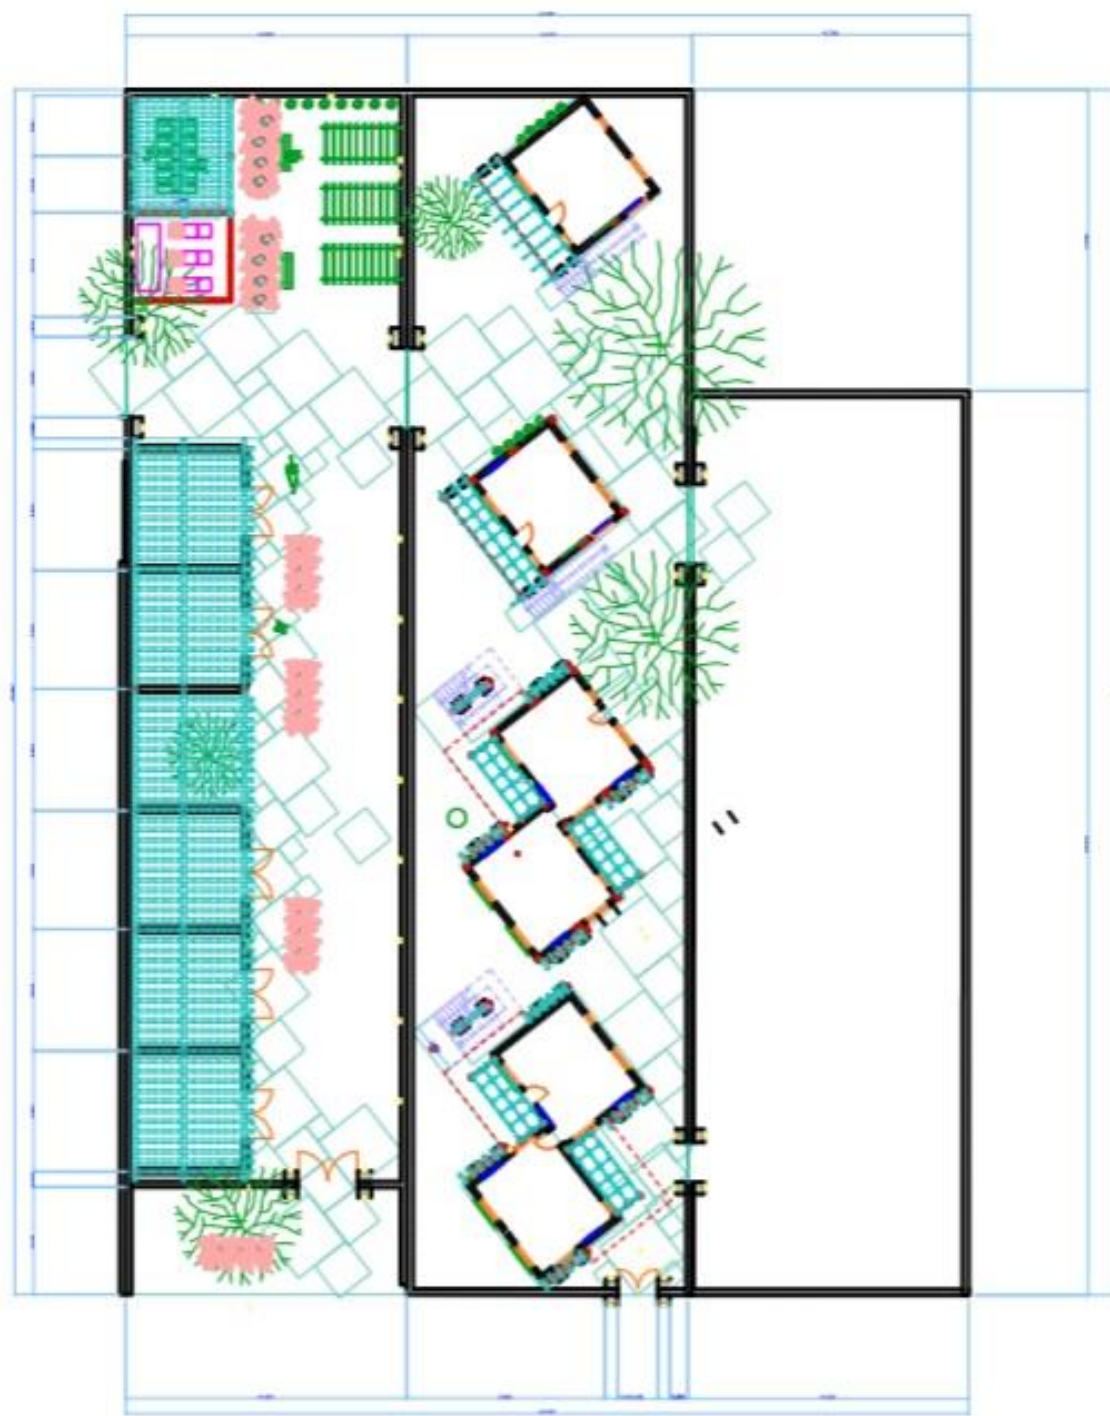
Plantas Arquitectónicas 3D Modelo Familiar.
